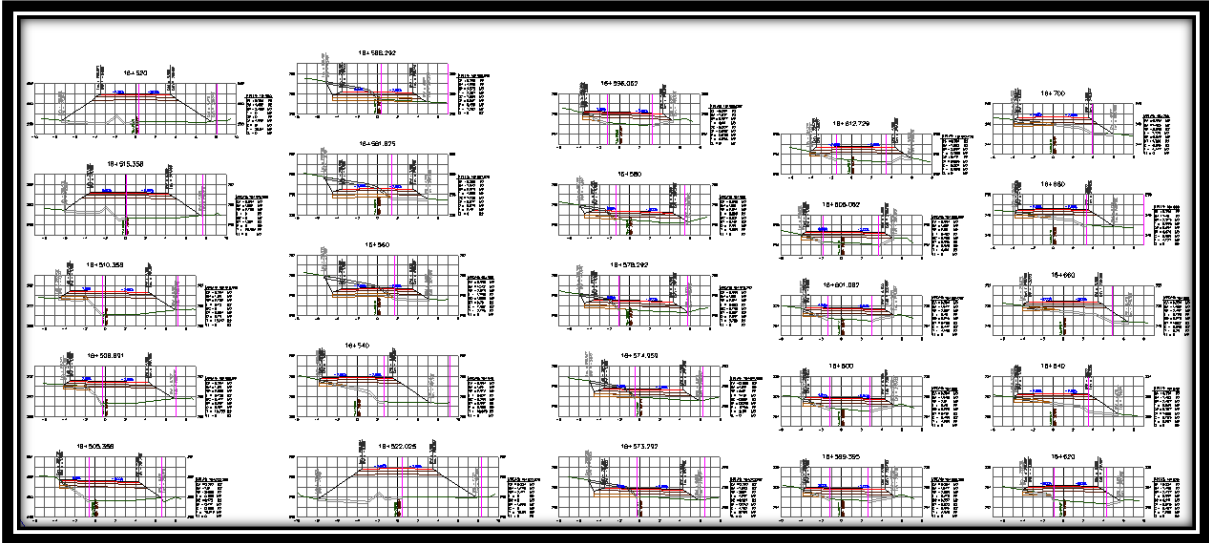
Secciones de construcción del km 16+505.358 al km 16+700.000.
